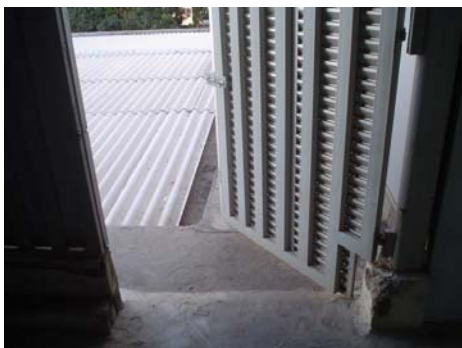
A saída da escada de emergência é para a cobertura das lojas dos pavimentos inferiores.
